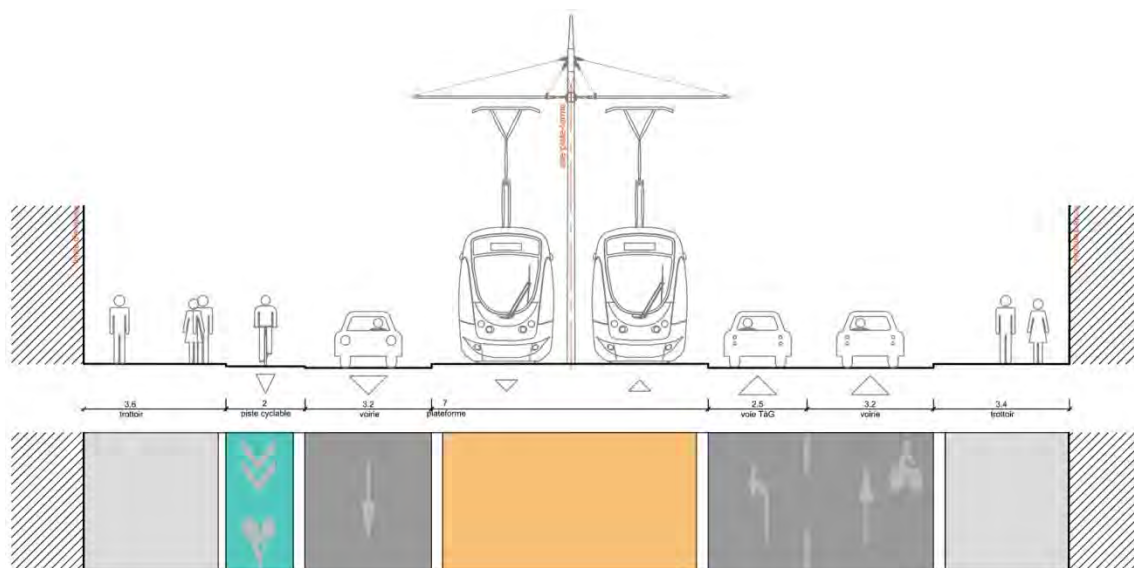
Coupe au droit d'une voie de tourner-à-gauche isolée
